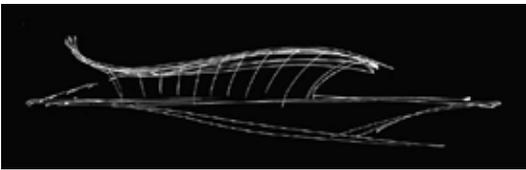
Diseño conceptual y arquitectónico (Ott Architects) y diseño estructural (Oak ingeniería)
